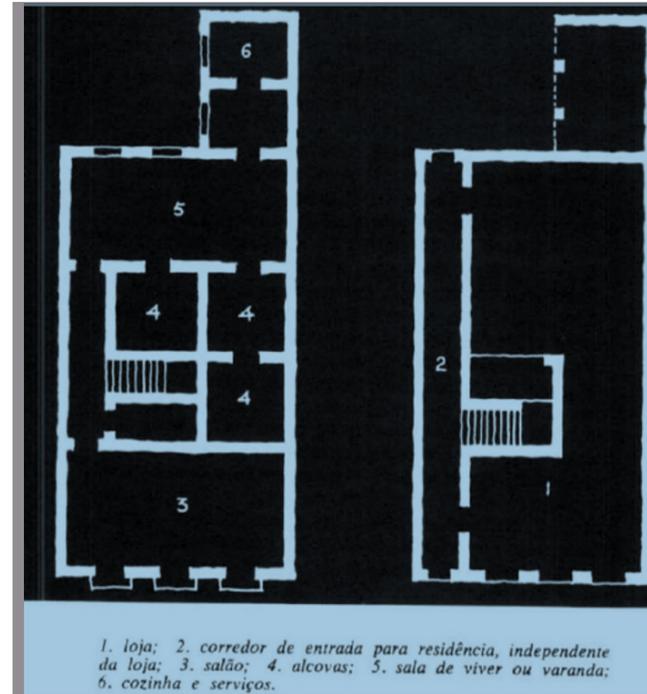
■ Configuração do padrão da planta baixa das casas coloniais.
